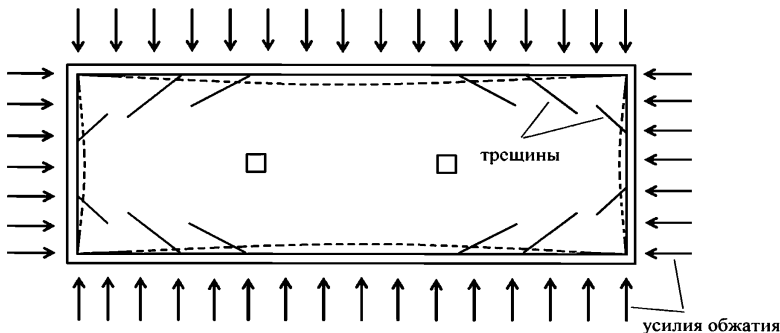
Образование доэксплуатационных трещин при обжатии перекрытий, связанных с наружными несущими стенами
